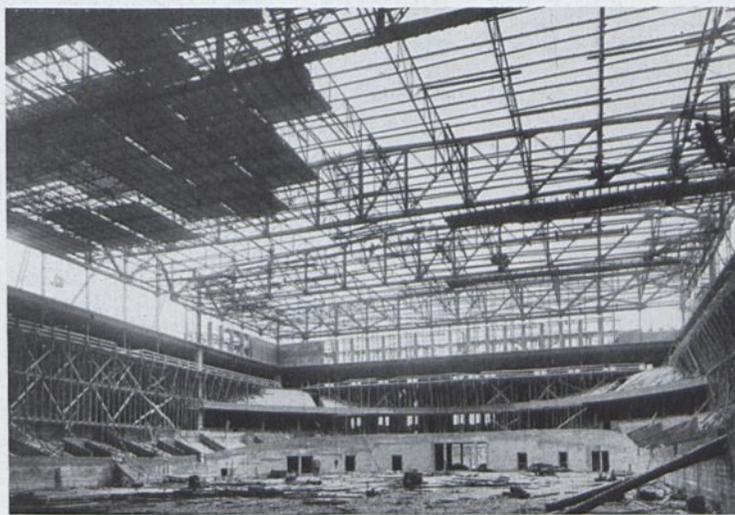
Stahlkonstruktion nach beendeter Aufstellung.
